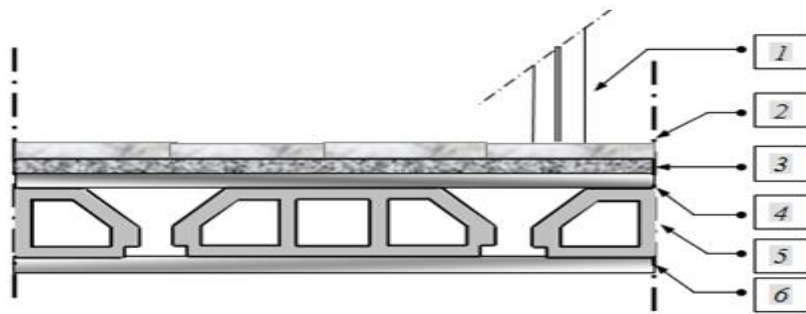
Coupe verticale du plancher courant à corps creux.
